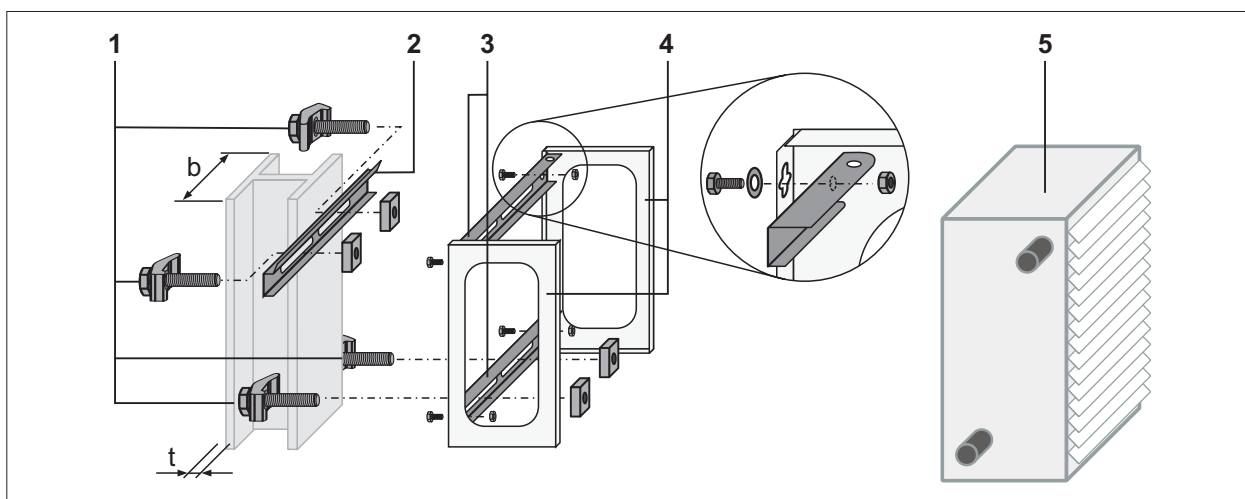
Монтаж воздухонагревателя к стальной балке с помощью набора для крепления
